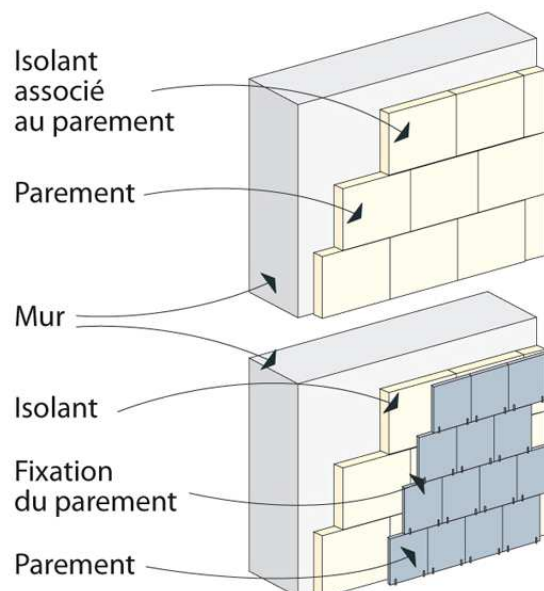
Exemple d'un parement.(Philippe Amadio,2007).
